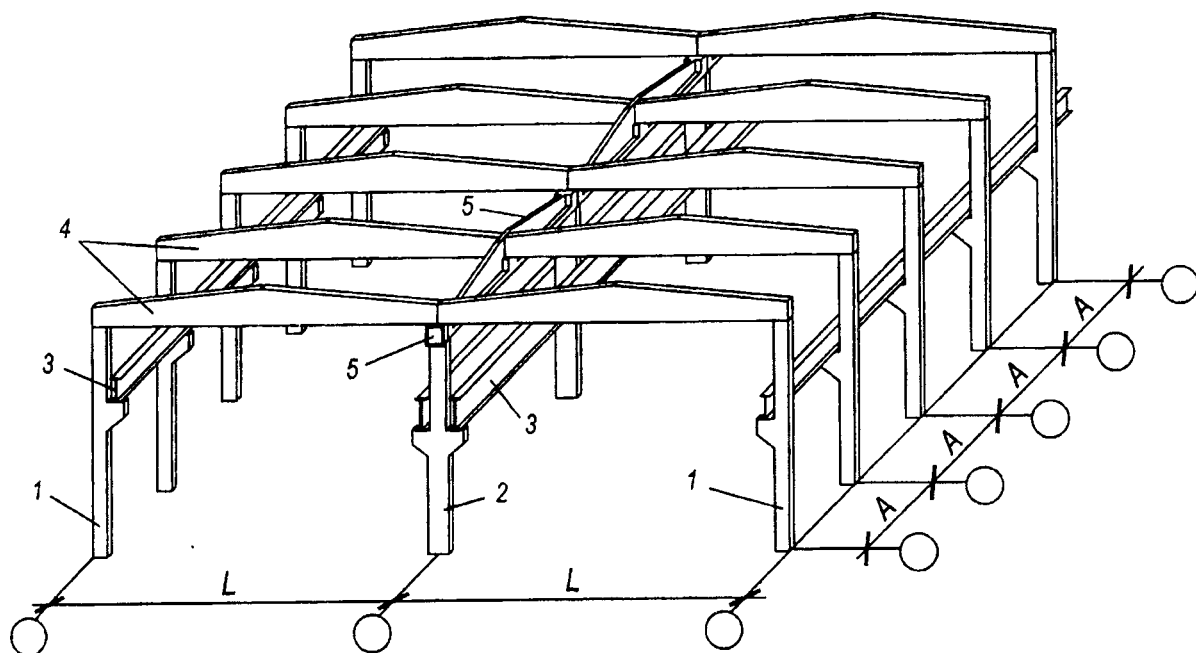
Несущий остов здания с плоскостными конструкциями покрытия:
